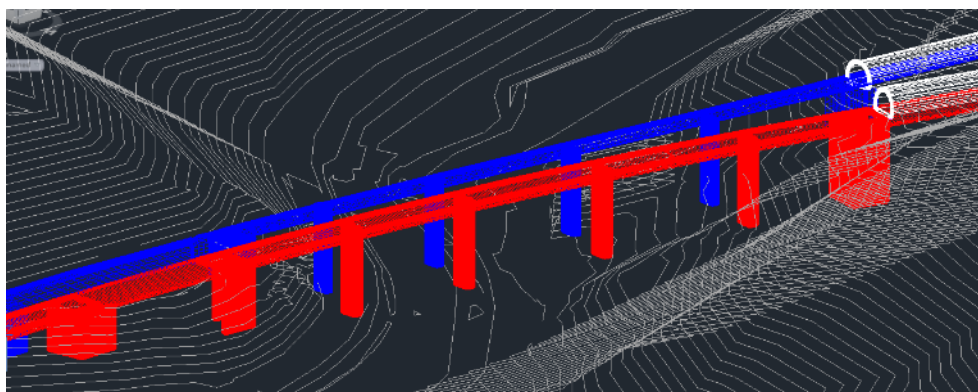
Prikaz pogleda na vijadukt Šum – varijanta 3 (plavo – postojeći, crveno – planirani)
